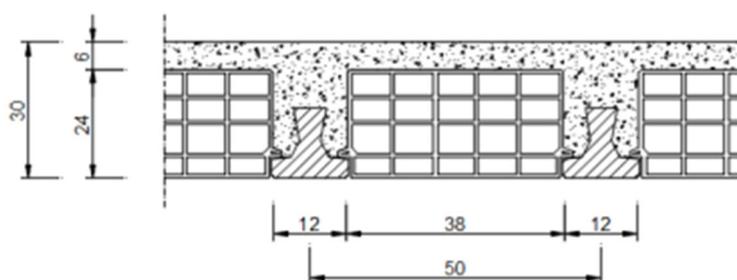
Particolare sezione resistente tipo del solaio in latero – cemento a travetti precompressi.
